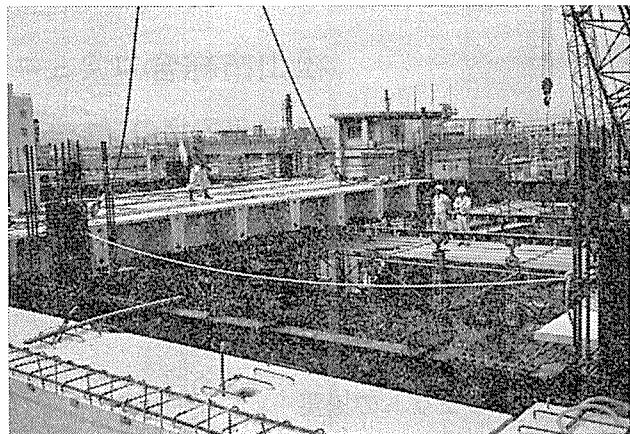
第 III 期工事の 1 次緊張されたプレキャスト 部材格子梁の架設状況
